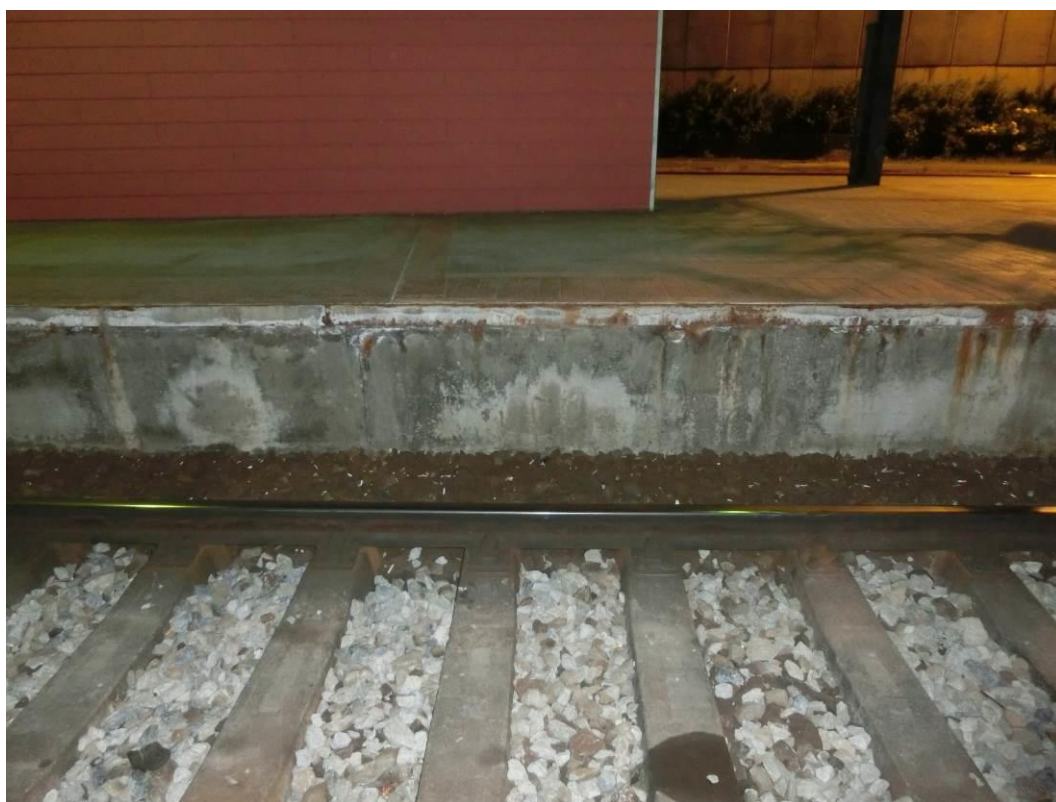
Pohled na nástupištní zídku – patrná degradace krycí vrstvy betonu
